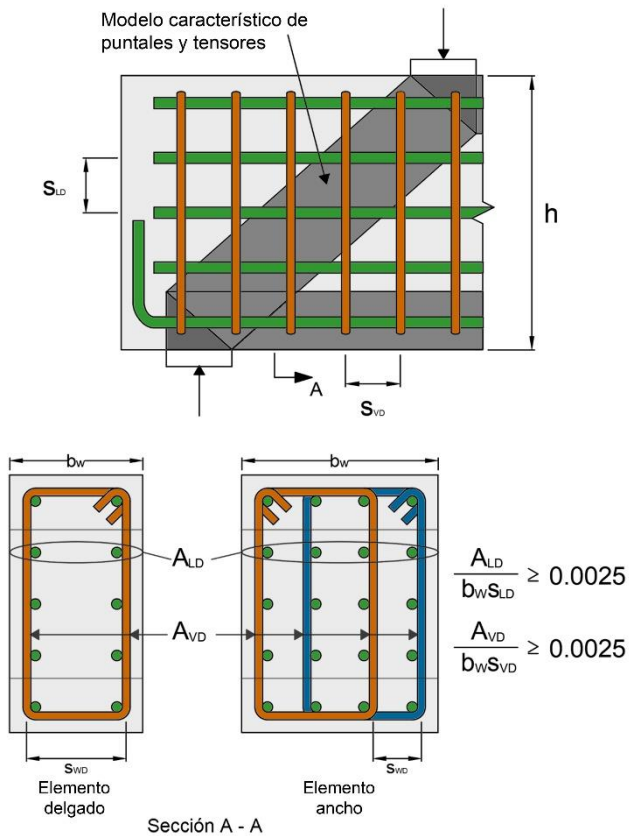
Refuerzo distribuido en elementos anchos (adaptada de ACI CODE-318-19)
